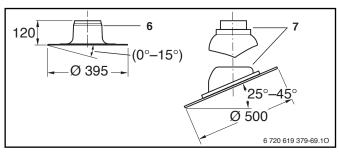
Tegola universale e flangia adesiva per tetto piano (quote in mm)
